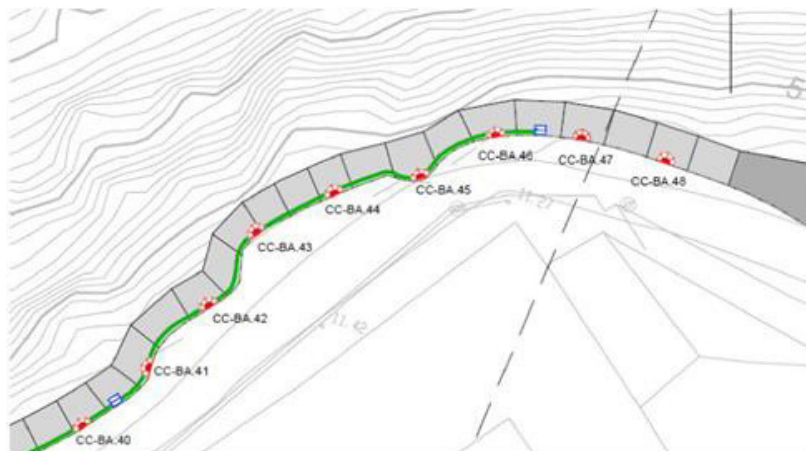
Propuesta de instalación eléctrica en planta en el tramo de muelle de pasarela metálica.
